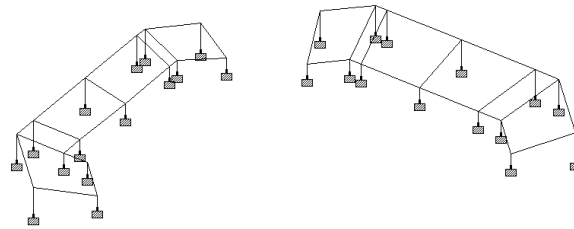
Geometría de la Estructura en Vista Isométrica
